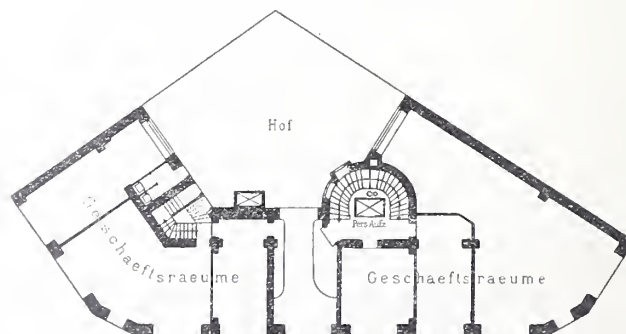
Kaufhaus Köln. Erdgeschoss 1:500.
